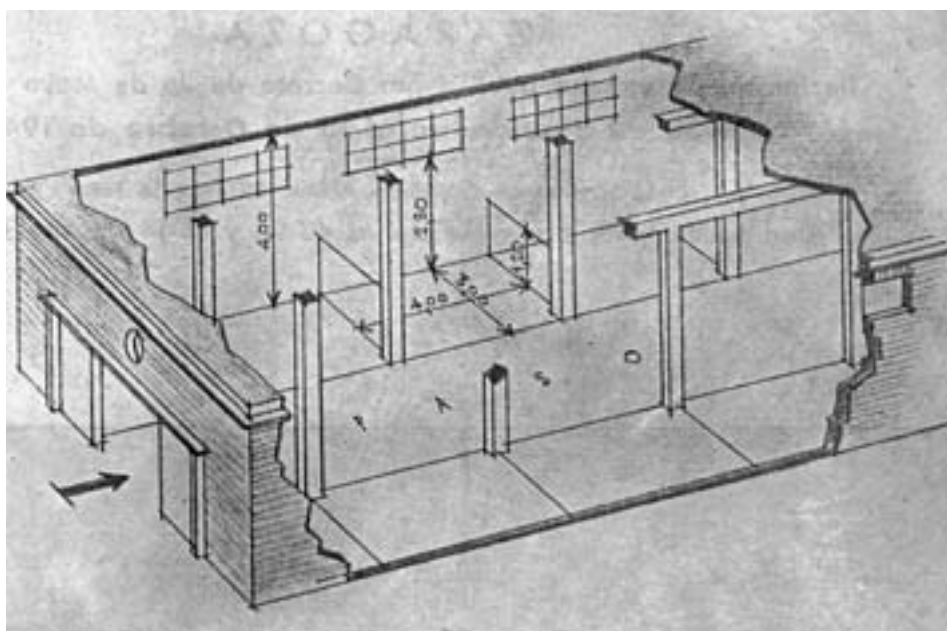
Sección y planta de los pabellones construidos en el interior del recinto ferial en 1945.
